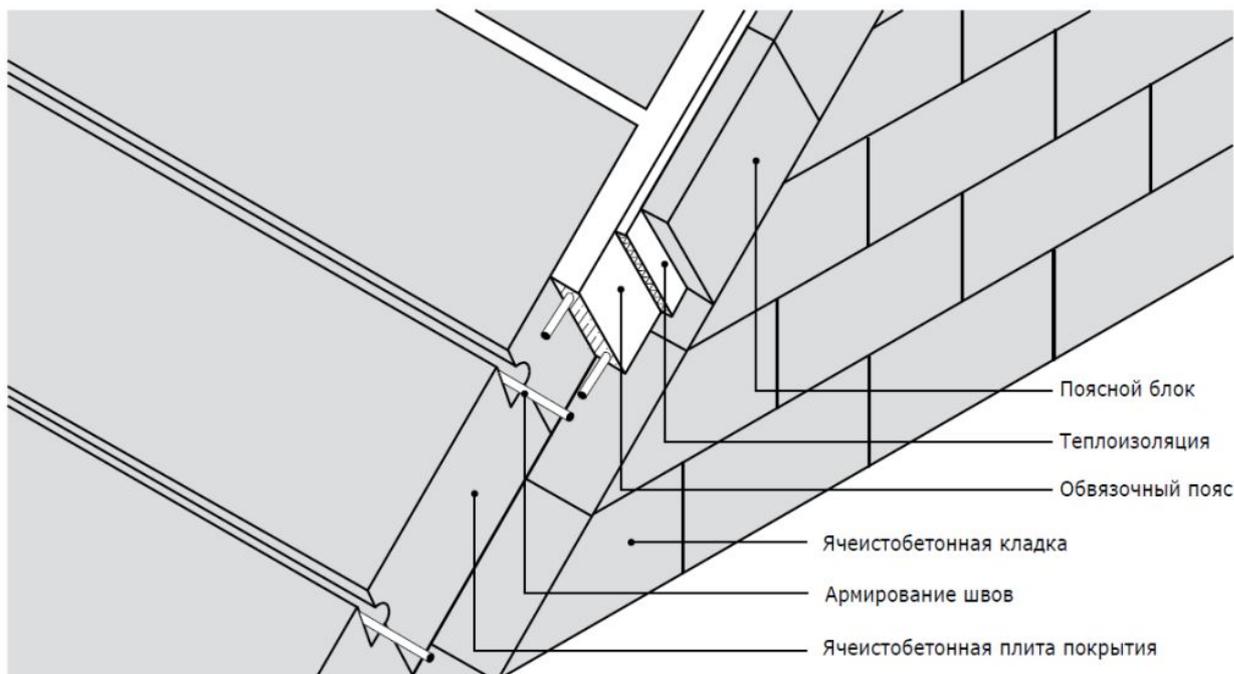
Зона сопряжения стена-покрытие. Одностороннее опирание панелей покрытия на кладку фронтона, обвязочный в уровне панелей
